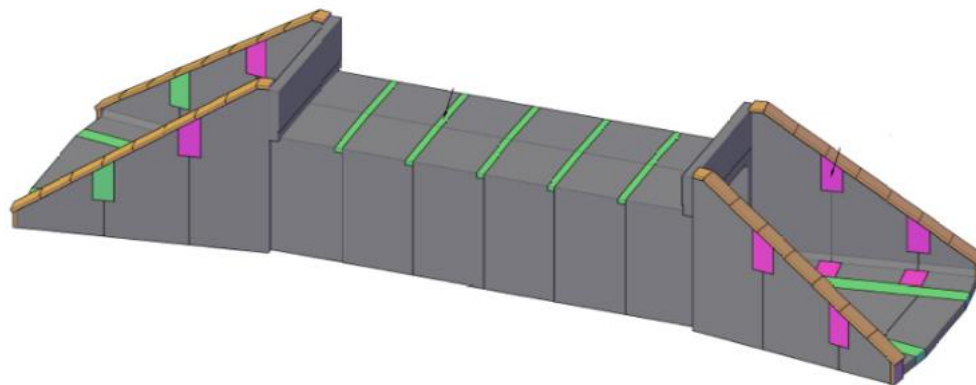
Exemple de passage souterrain piéton constitué d'éléments cadres BApréfabriqués
